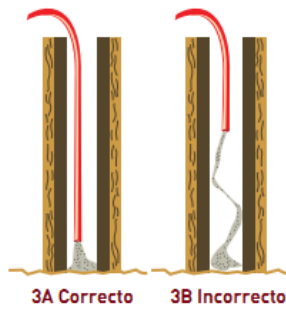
Vaciado del concreto en columnas y placas (UNACEM, 2014).
